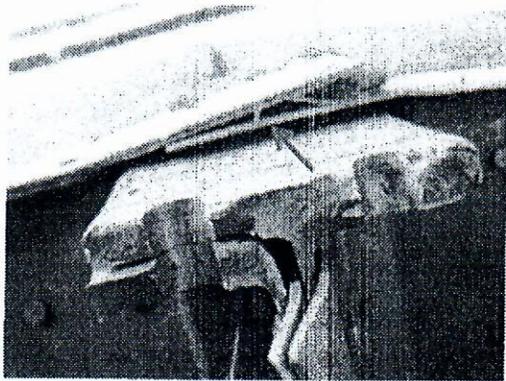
Remaches sueltos en la parte superior del plano derecho.
